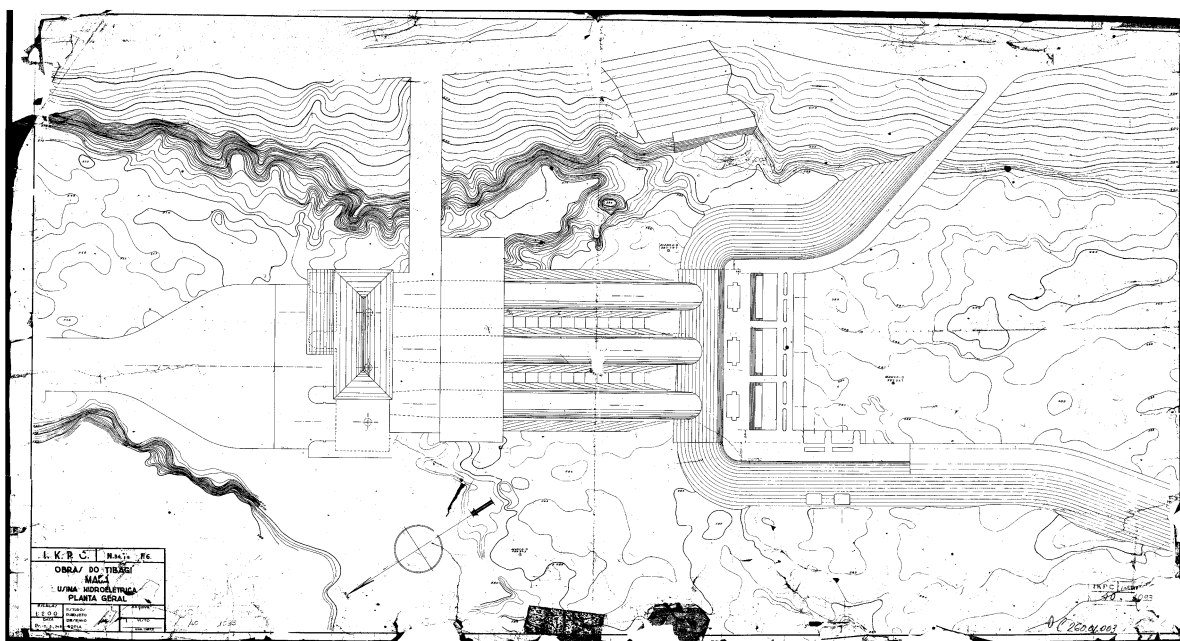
PLANTA BAIXA DO CONJUNTO DE ADUÇÃO, CONDUTOS FORÇADOS, CASA DE FORÇA E CANAL DE FUGA (0C-260-01-003).
